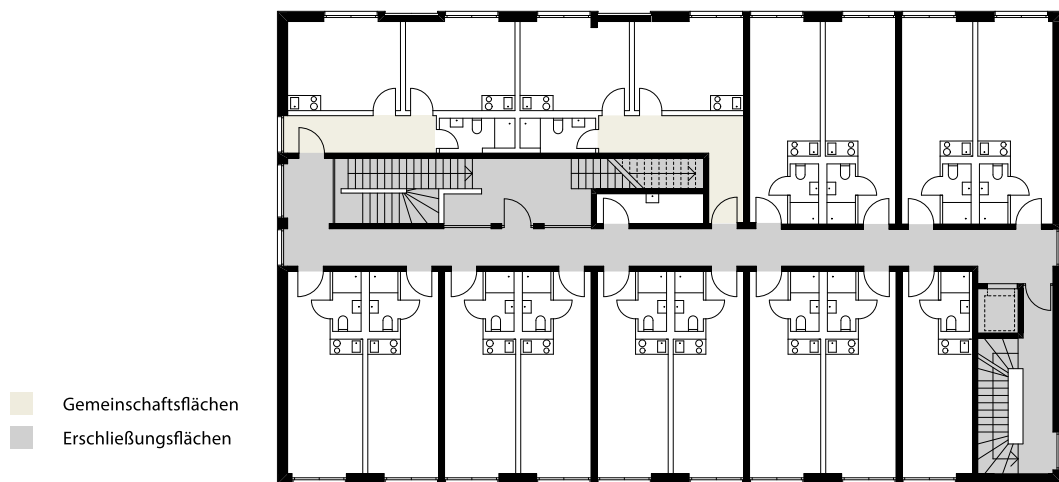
Grundriss Regelgeschoss mit erkennbarer Schottenbauweise und Mittelflurerschließung, M. 1:300 [© BF Vario]
